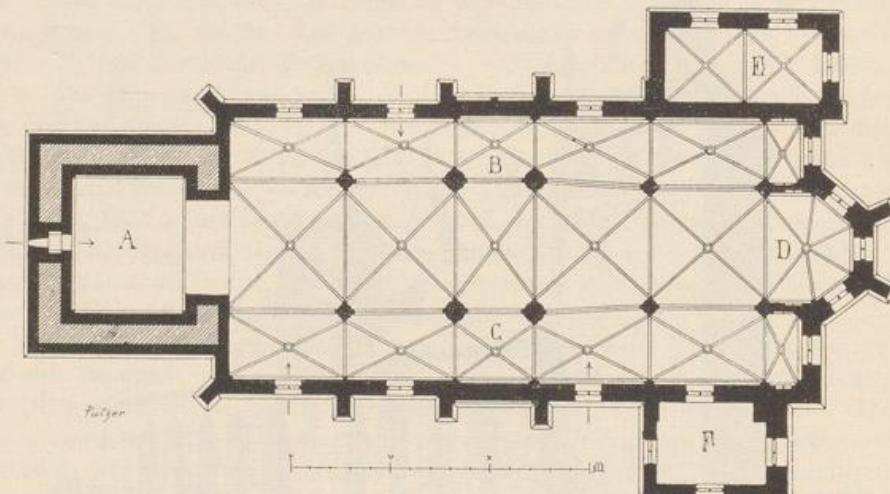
Ratingen. Grundriss der katholischen Pfarrkirche.
